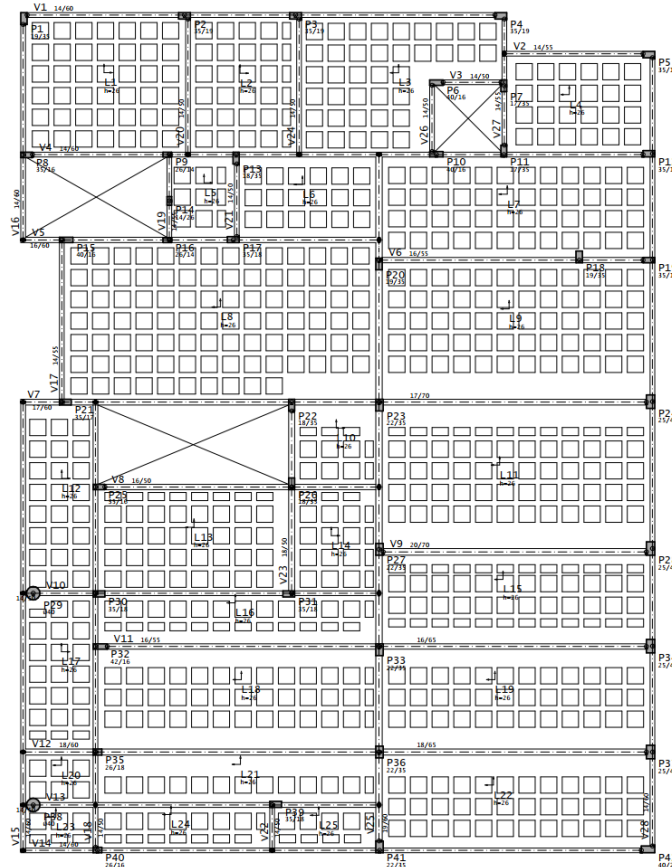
Planta de fôrma do sistema de laje nervurada bidirecional em concreto armado no TQS. (Fonte: Autoria própria; 2023)
